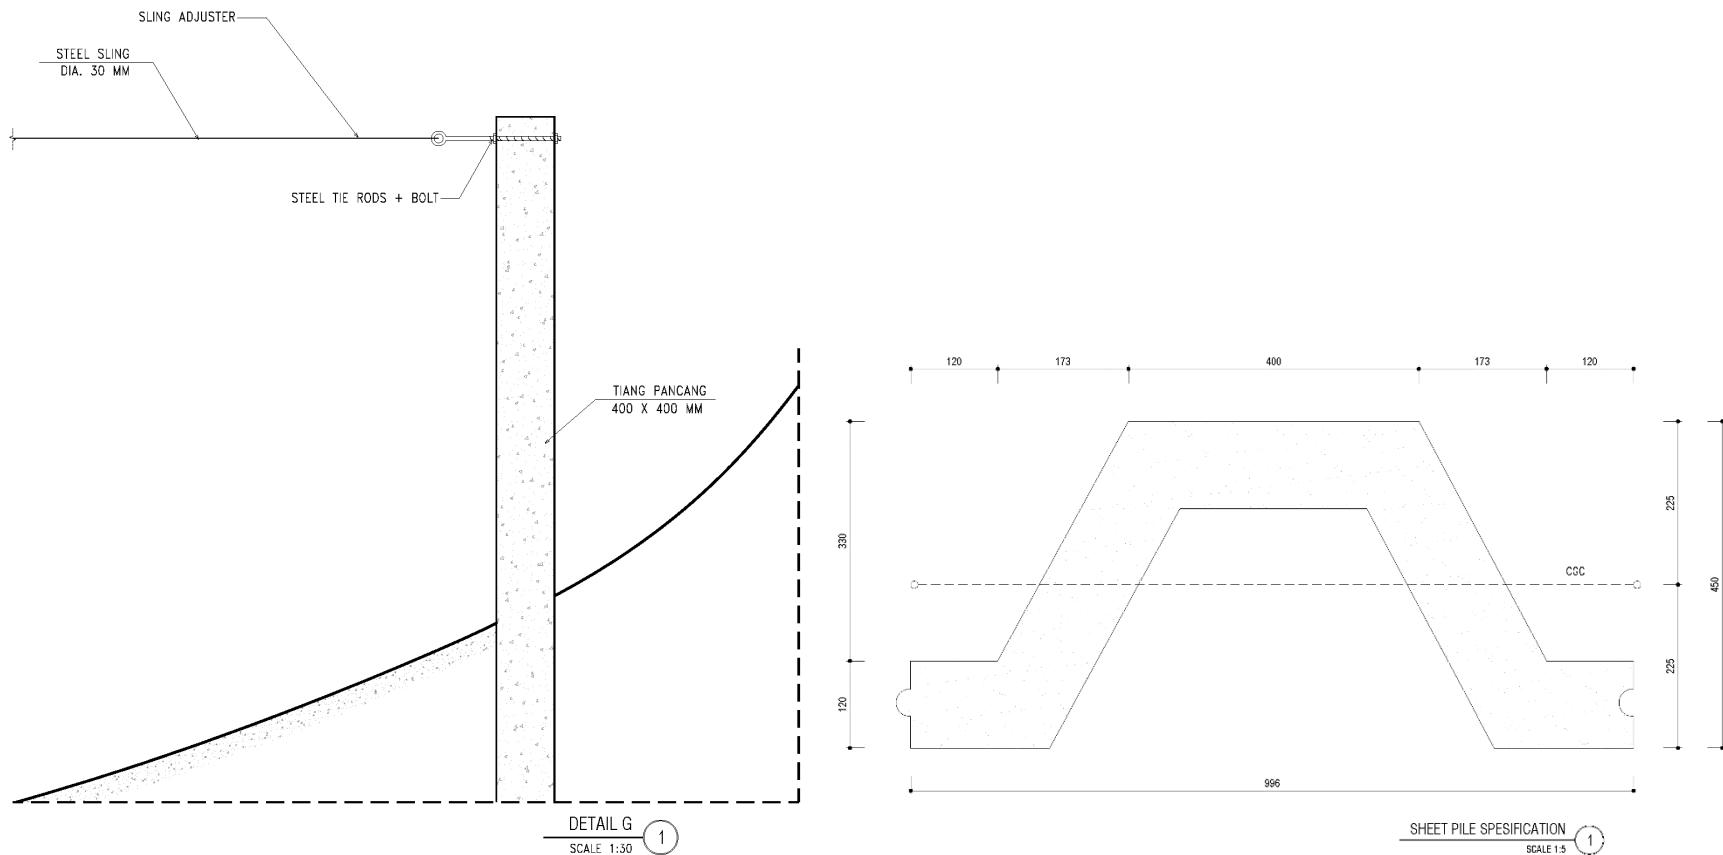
Tampak Atas dan Potongan Alternatif 1 *Sheetpile
